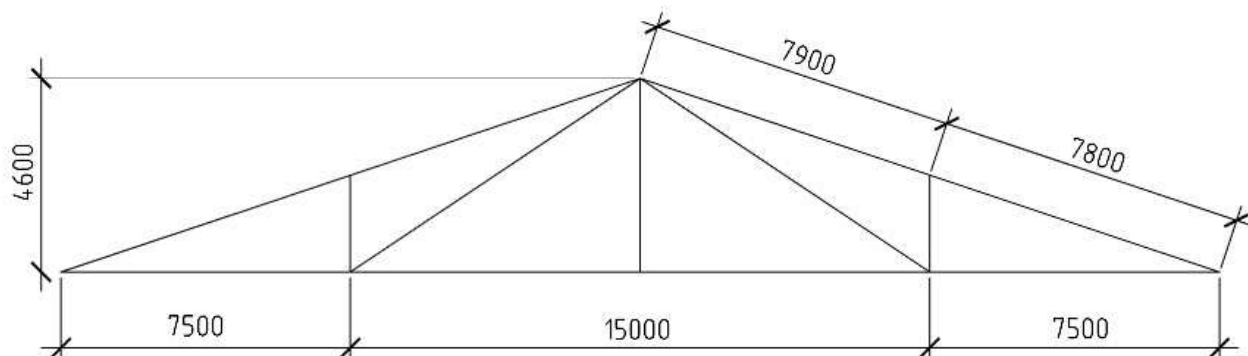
Металлодеревянная ферма с клееным верхним поясом
